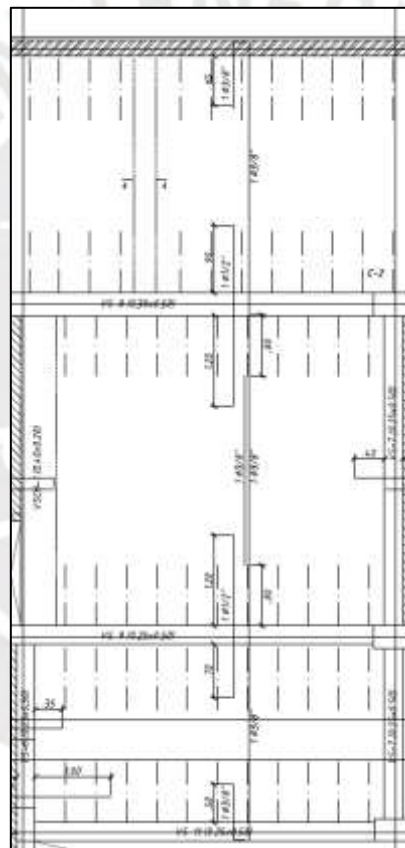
Disposición de acero de refuerzo en el techo aligerado de la vigüeta 1
